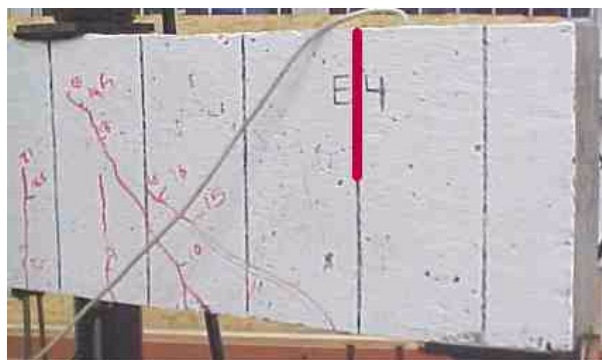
Detalhe da fissuração em E4 e posição dos extensômetros
